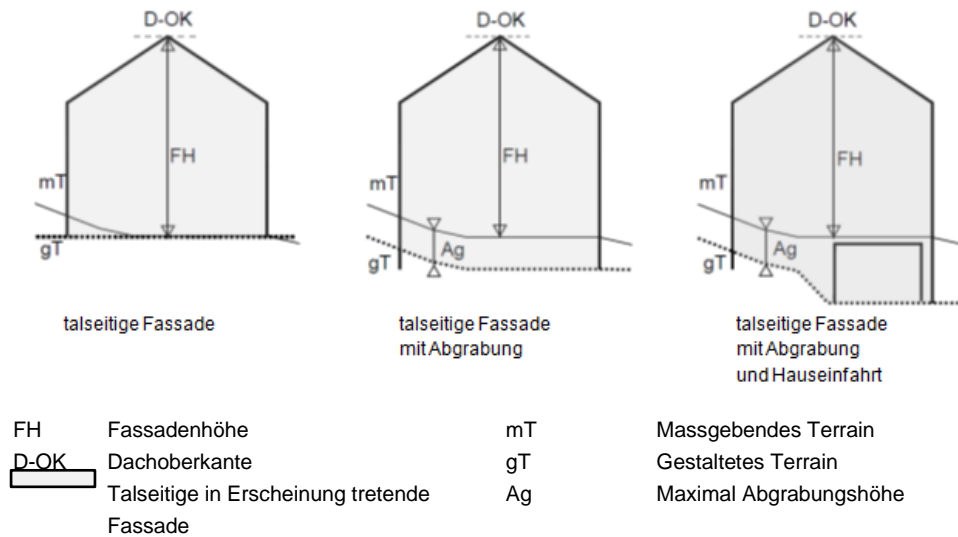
Fassadenhöhe, Abgrabung, Hauseinfahrt
